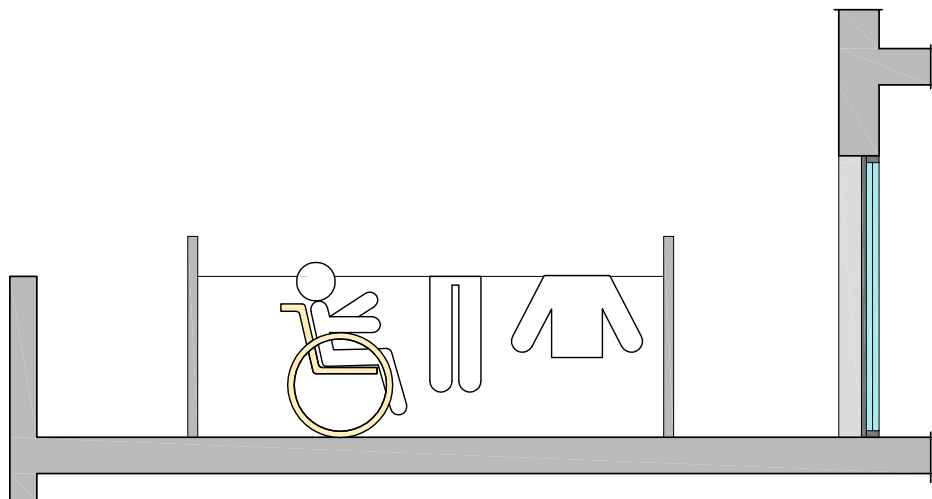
Detalle acceso a terraza y colocación del tendedero.
